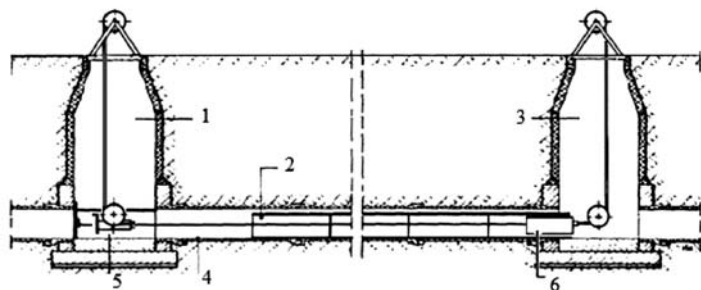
Монтаж нового трубопровода без растягивающих усилий:
